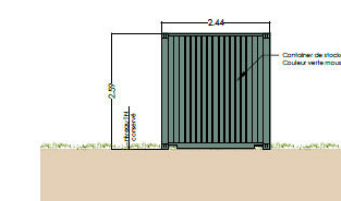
Plans des façades du container de stockage (source: wpd Solar)
